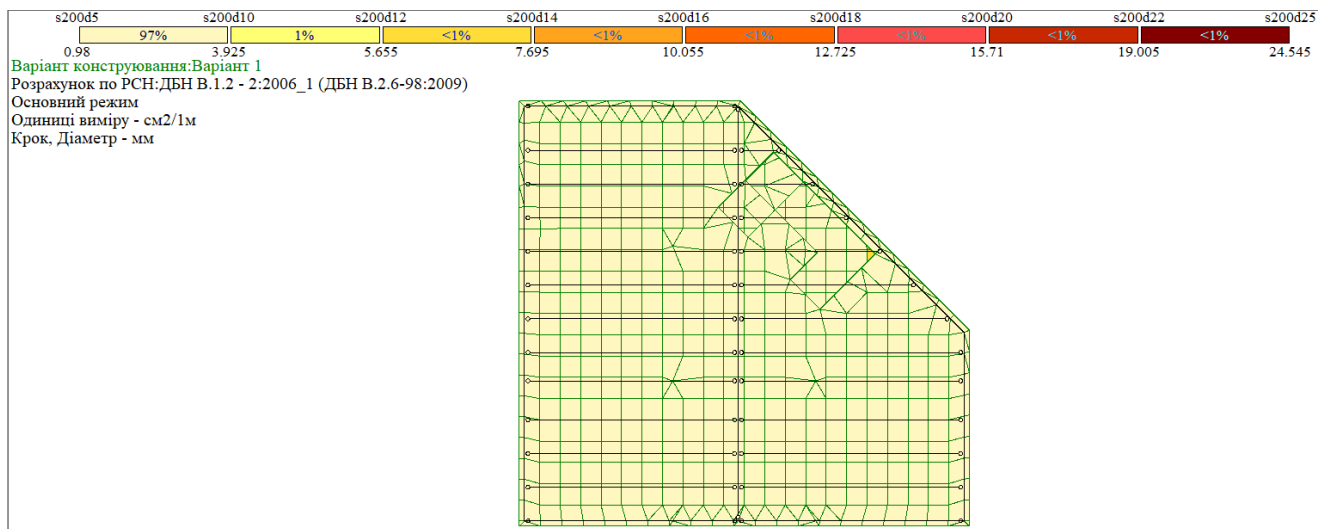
Площа арматури на 1 м. п. по осі y (нижня грань)
